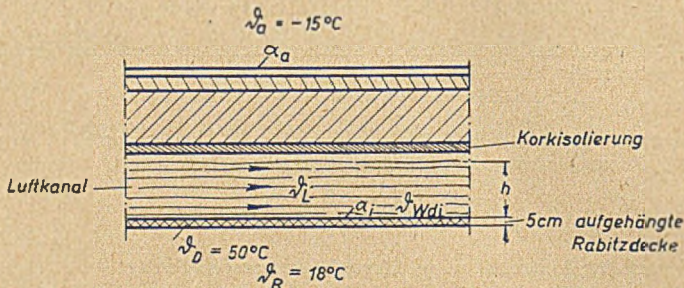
Deckenausführung bei einer Warmluftdeckenheizung.
